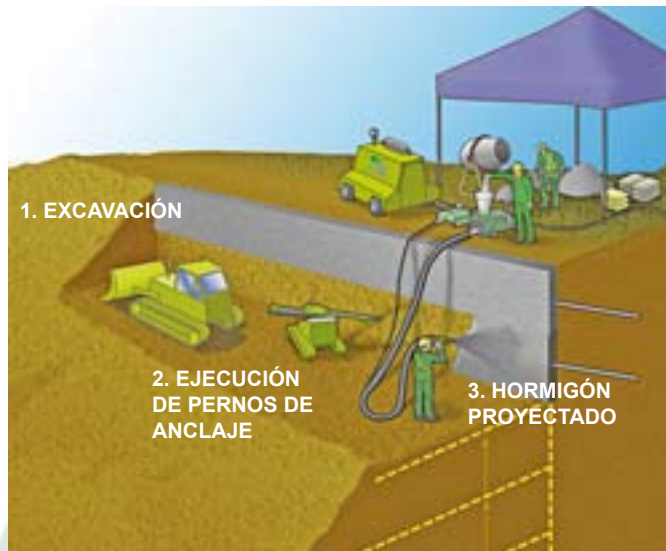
Fases constructivas en corte. Ejemplo de excavación mecanizada.
